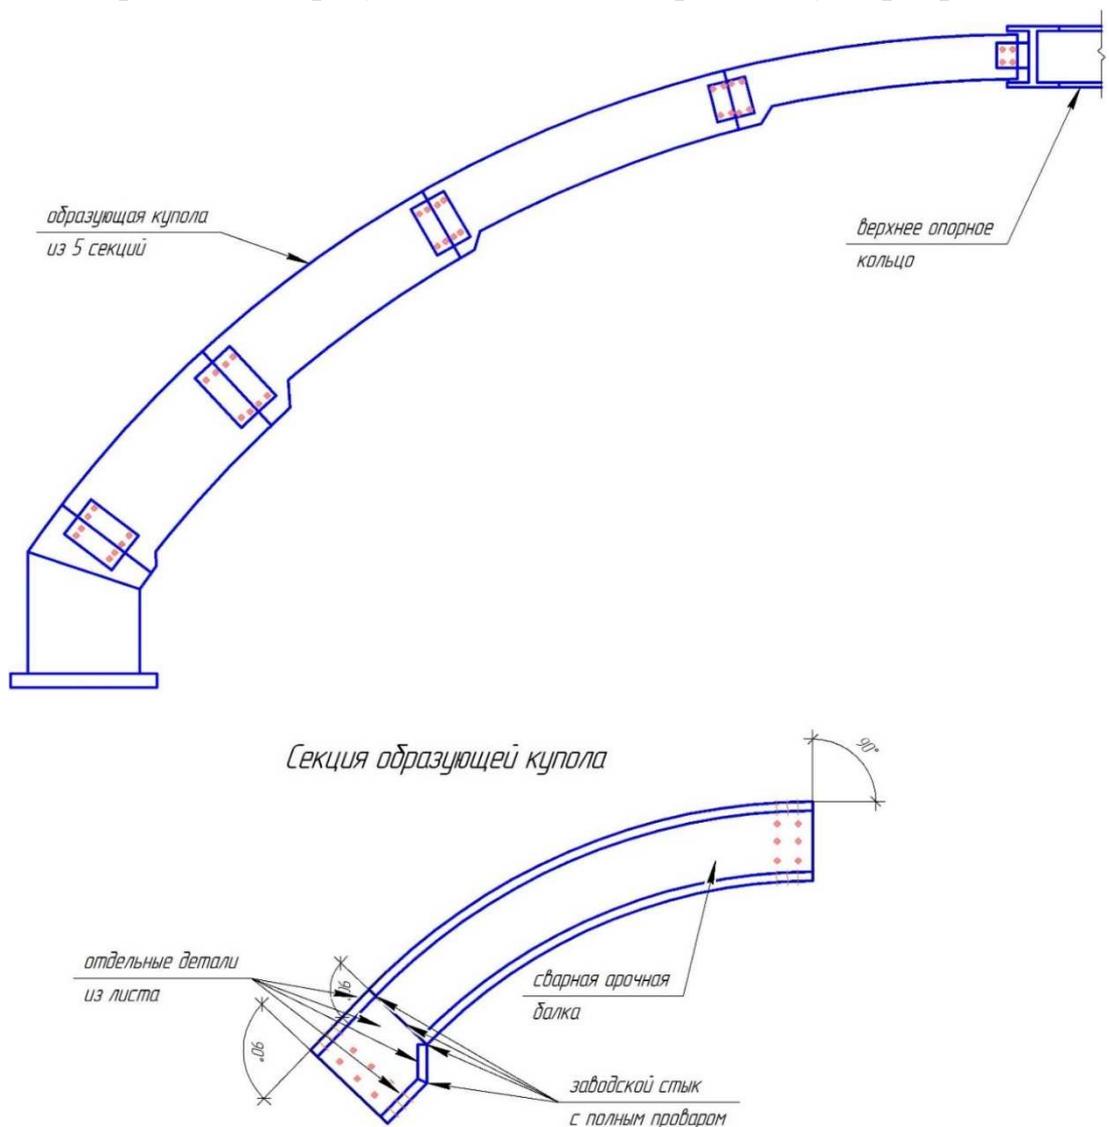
Купол с образующей в виде сварного двутавра
